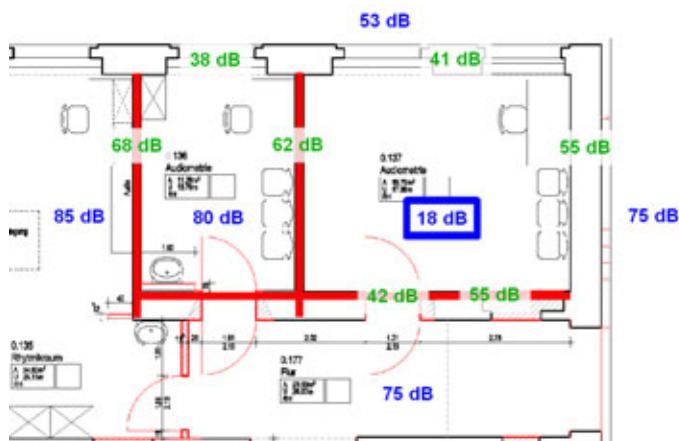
Grundriss des Audiometriebereiches mit Angabe der erwarteten Schalldruckpegel im Raum (blau) und der erforderlichen Luftschalldämm-Maße (grün)
